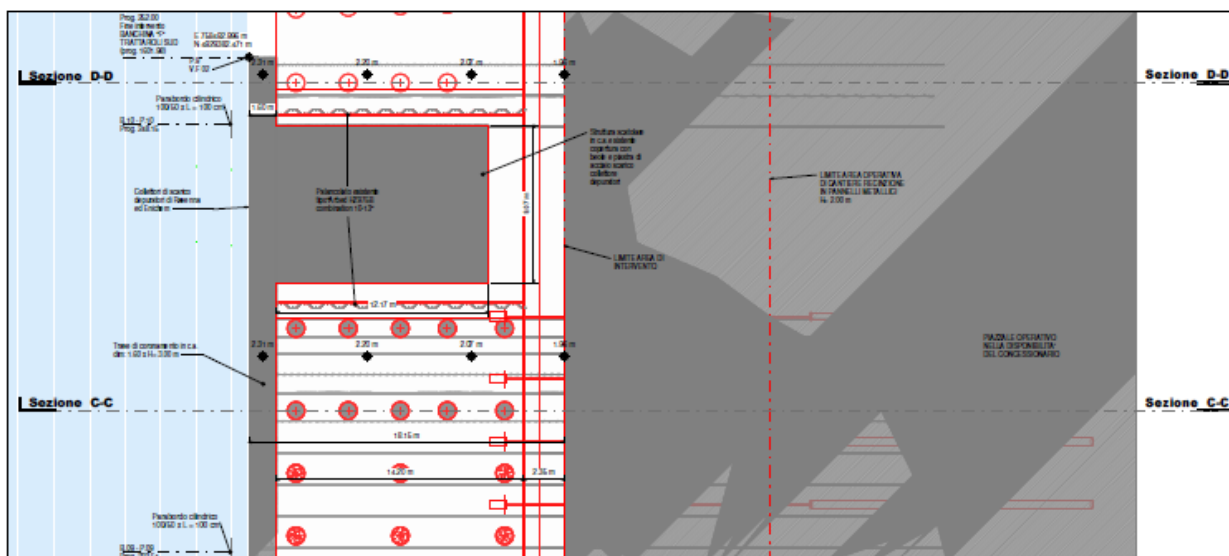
Stralcio planimetrico intervento di adeguamento in corrispondenza dello scolmatore
